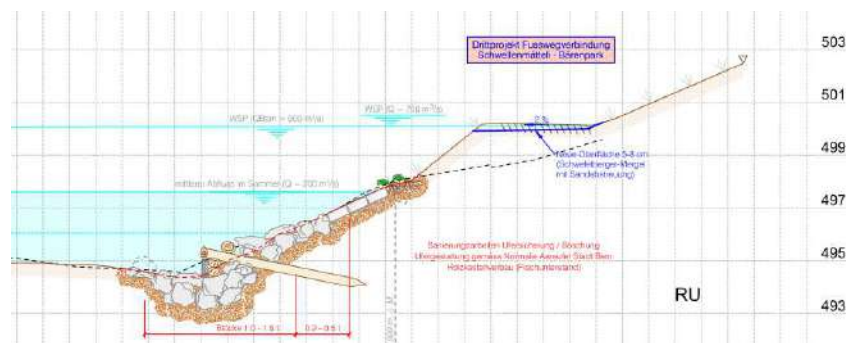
Querprofil im Bereich km 29.481, Wasserbauplan Beilage B.3.5
